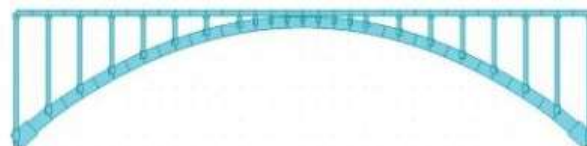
Modelo correspondiente a la Fase 2 de construcción: Estructura completa, con el tablero unido monolíticamente con los montantes
